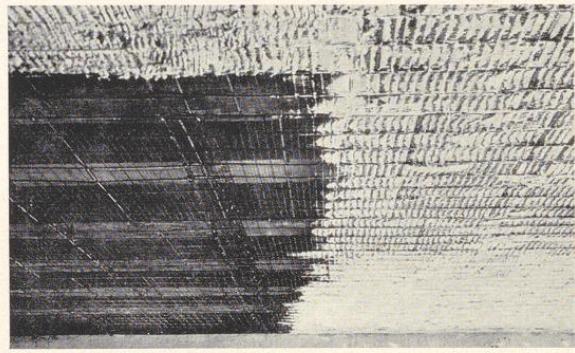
Baustahlgewebe an Holzbalken direkt befestigt,
